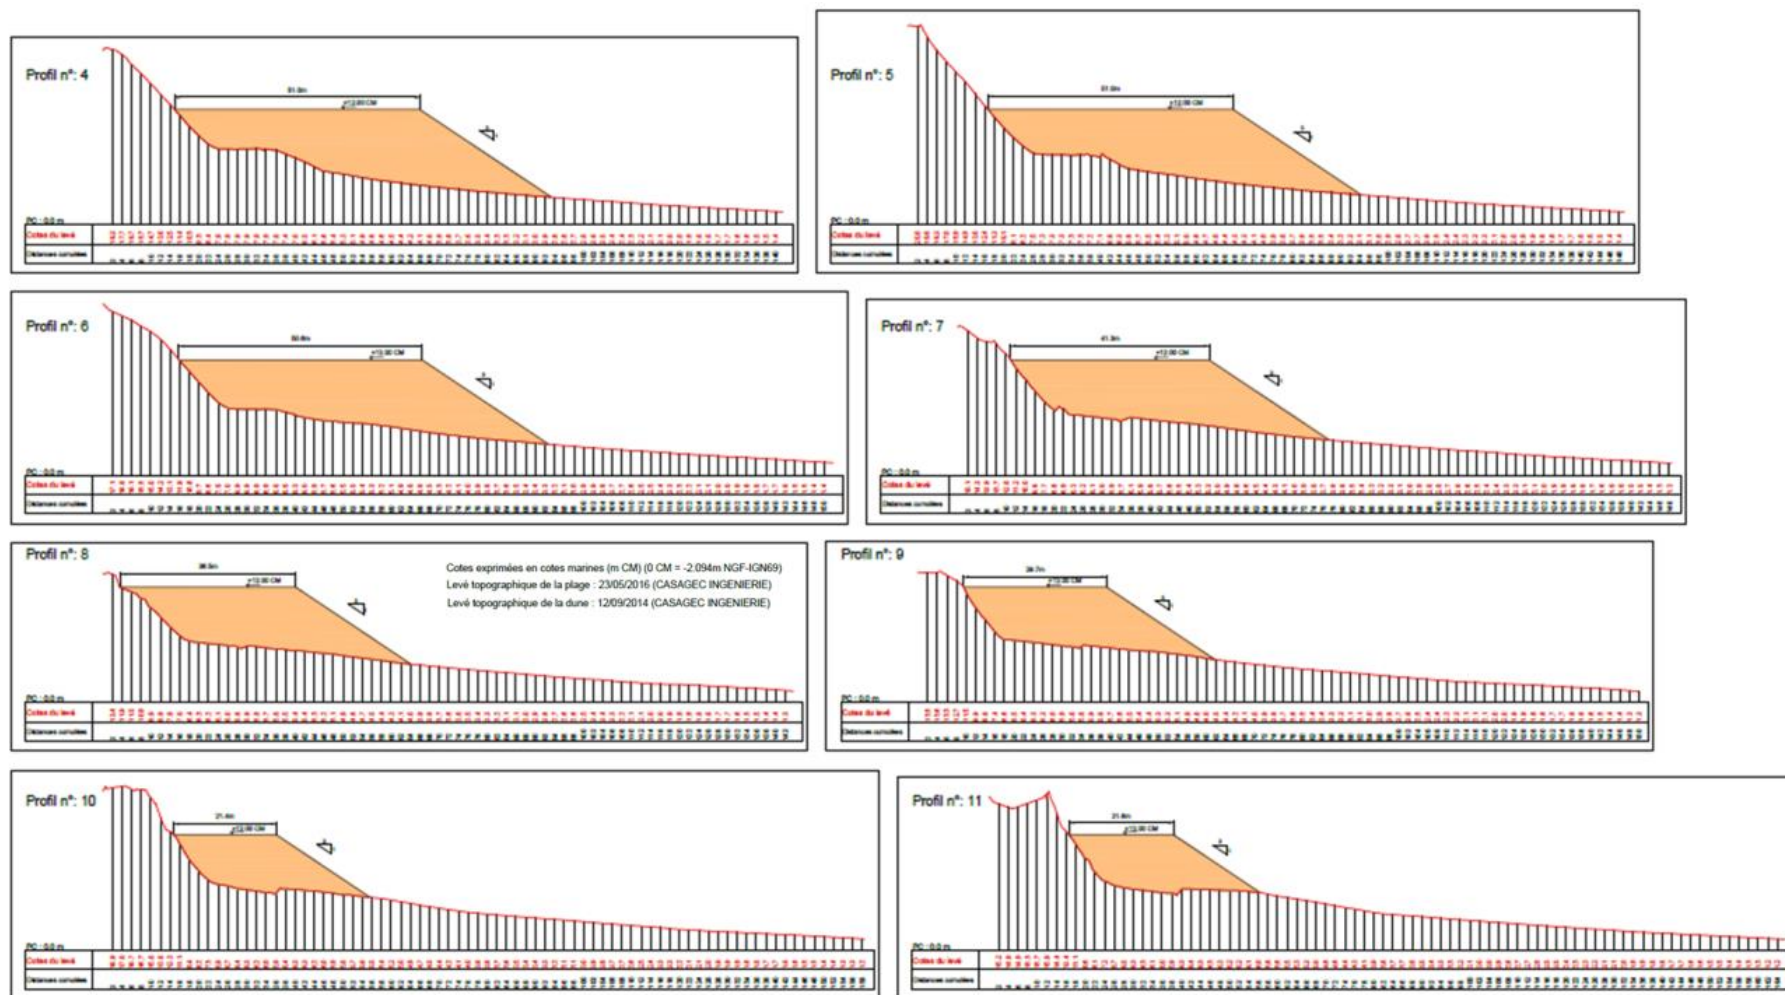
Profils type des rechargements des plages Sud (plage de la Savane à la plage de la Piste) 1/2.
